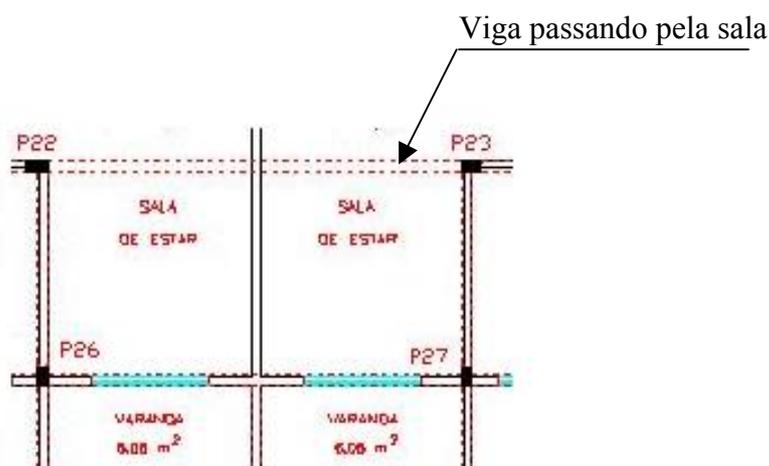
Detalhe da planta mostrando a viga aparente passando pela sala
